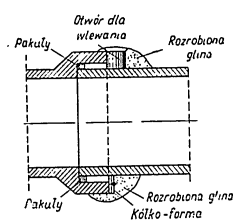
Forma dla zalewania styków rur masą izolacyjną
